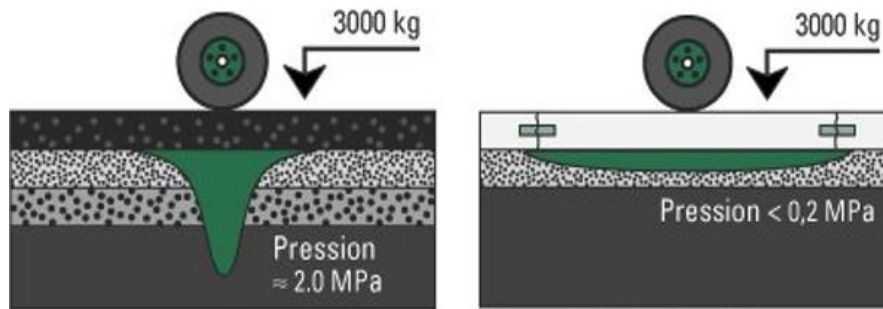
Structure type d'une chaussée bitumineuse épaisse [4]
